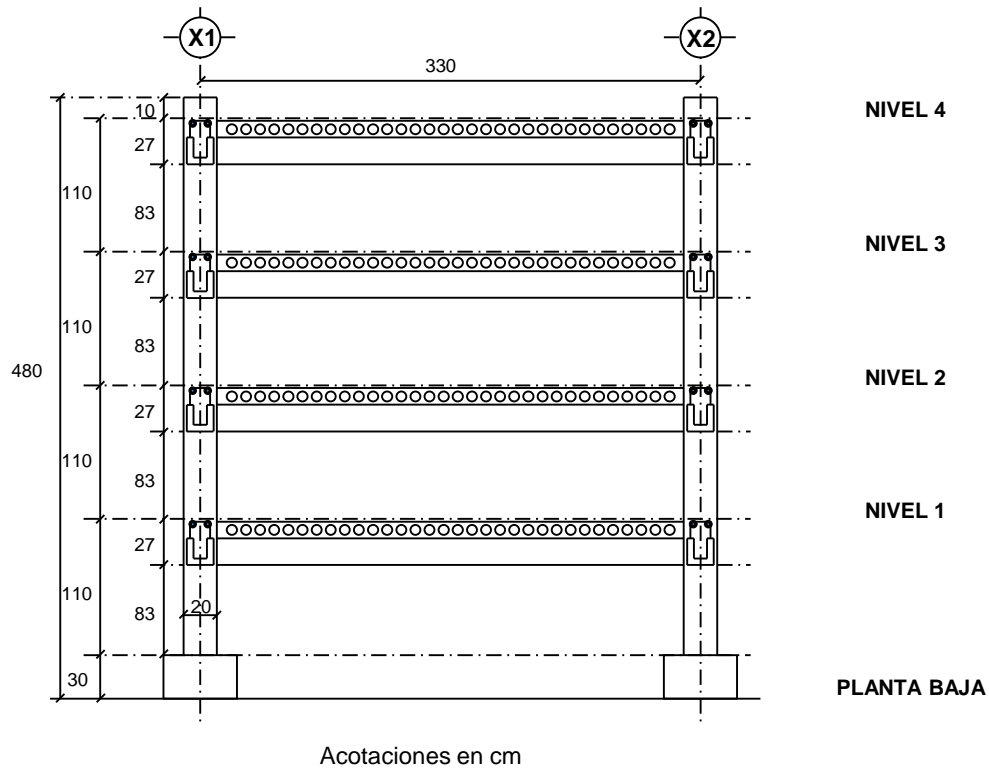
Vista en elevación de los marcos de la dirección transversal
